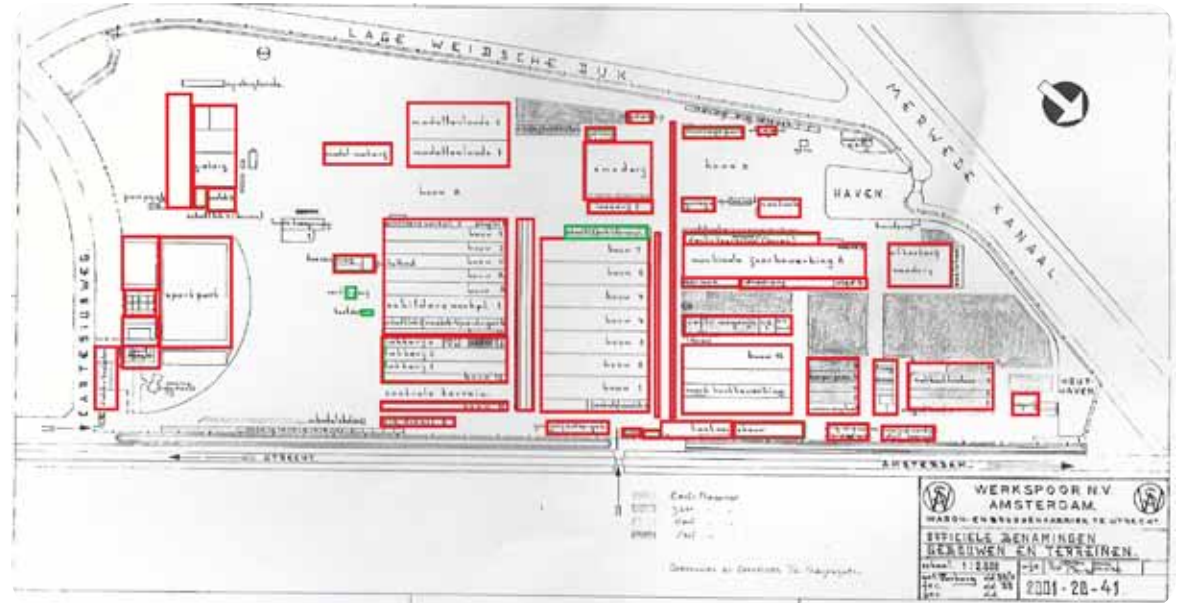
Plattegrond Werkspoorterrein 1930. Rood: bestaande bebouwing,
